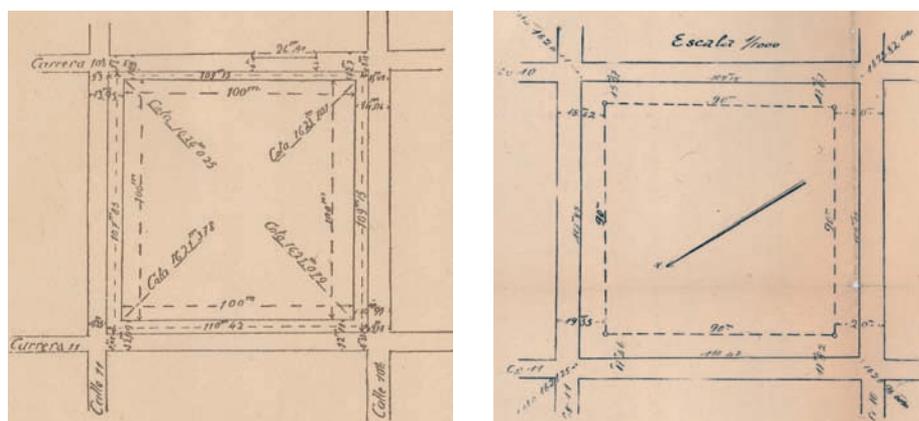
Izq. Plaza de mercado. Concurso para levantar planos. Detalle terreno de 100 m x 100 m. junio 6 de 1917. Der. Plaza de mercado. Concurso para levantar planos. Detalle terreno de 90 m x 90 m. agosto 25 de 1917.
